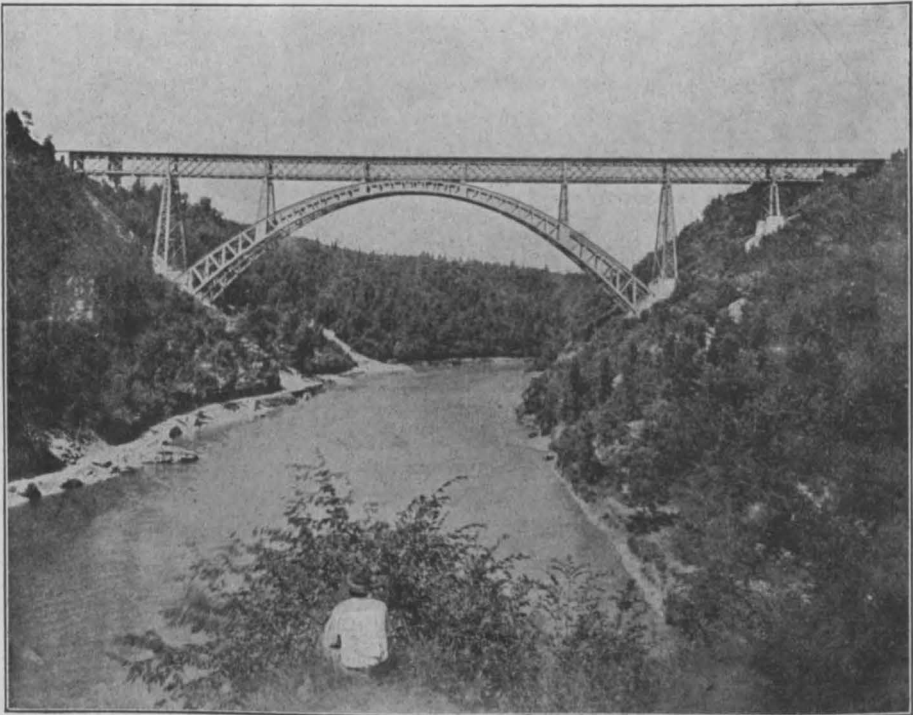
Straßen- und Eisenbahnbrücke über die Adda bei Paderno. 1889.
